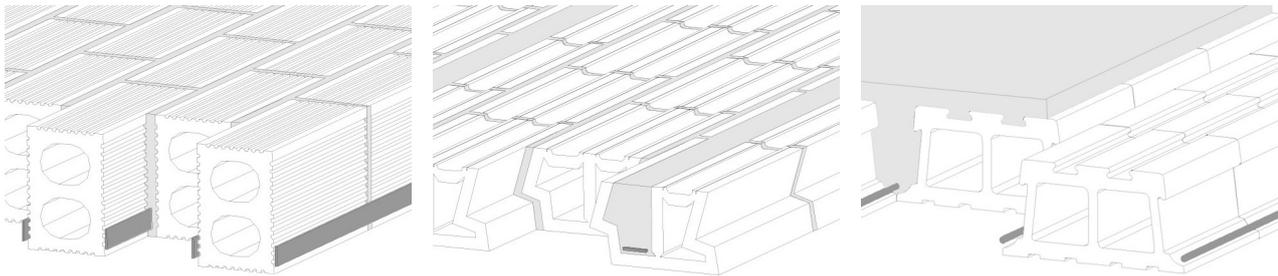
(left): Kleinesche Decke; Figure 8 (middle): Förster-Decke; Figure 9 (right): Reformhohlsteindecke
